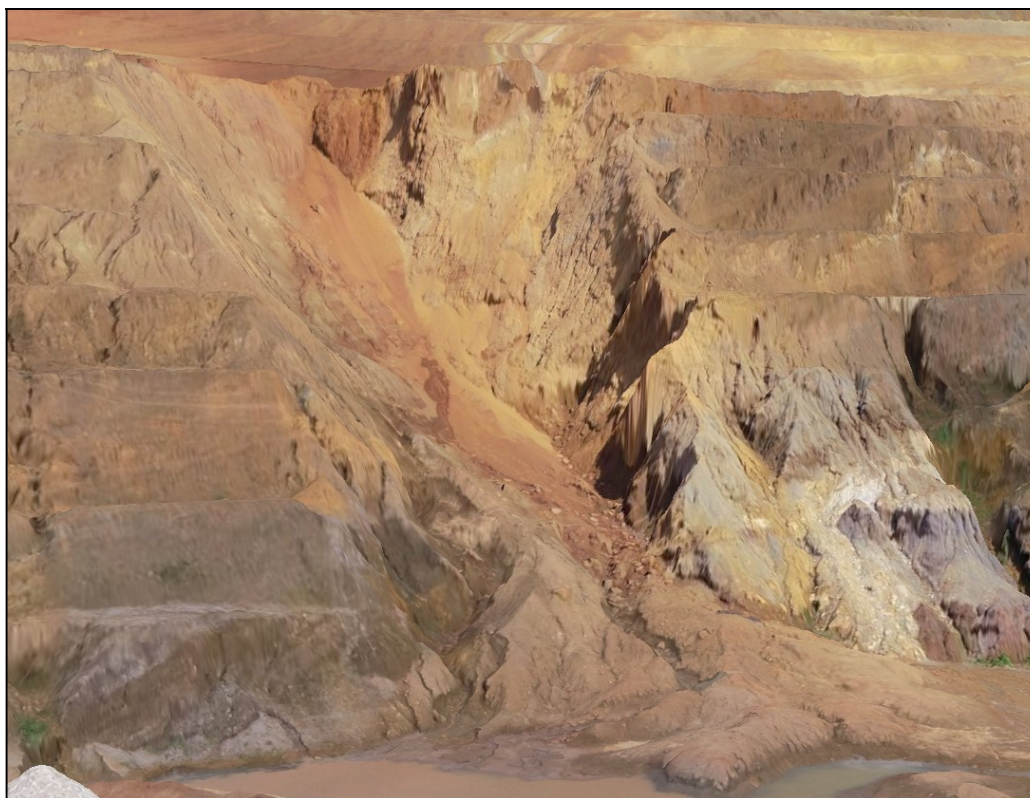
Ruptura do Talude Sul – Vista Inferior (Fonte: Propeller)
